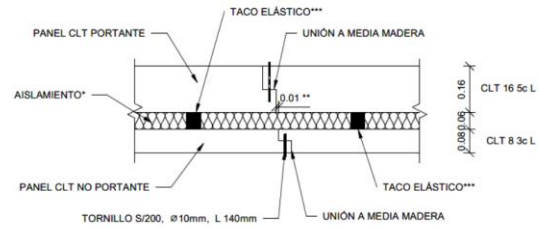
Detalle estructura panel sándwich. Fuente: Elaboración propia
